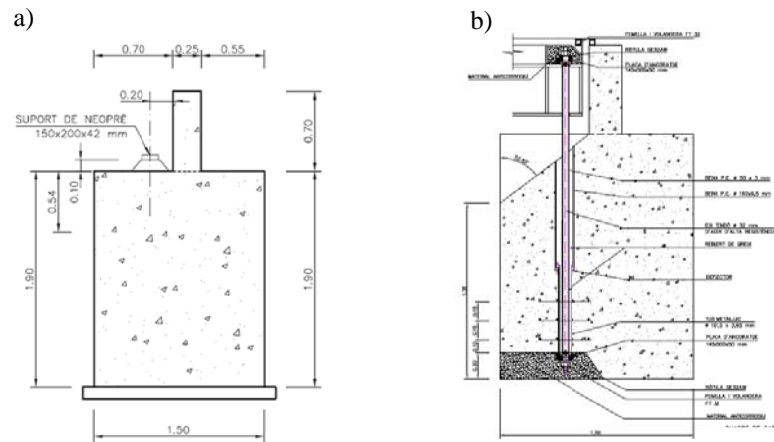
a) Plànol núm.19.2 full 5 Secció A i b) Plànol núm.19.2 full 5 Detall ancoratge.
